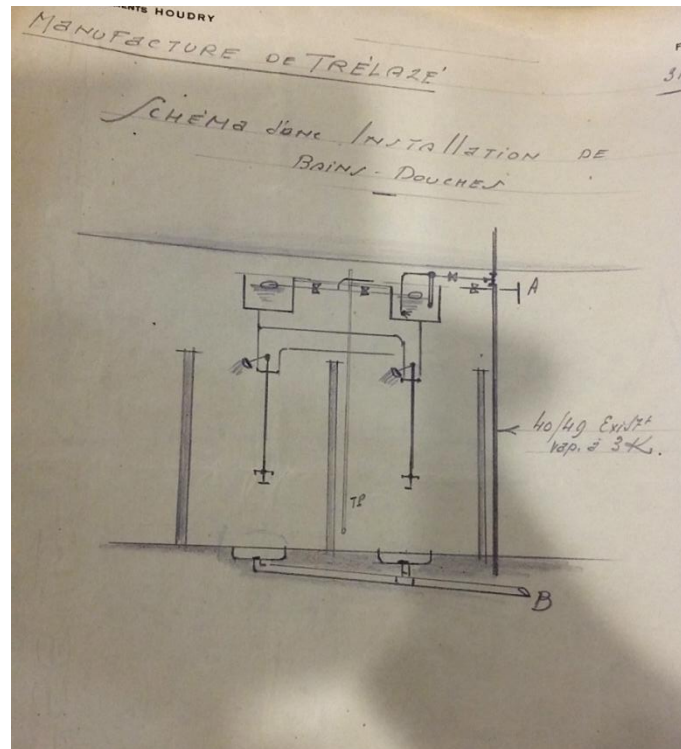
Schéma d'une installation de bains-douches dans le second site de la manufacture d'allumettes de Trélazé, 1925-1936 (ADML, 1044 W 154)
